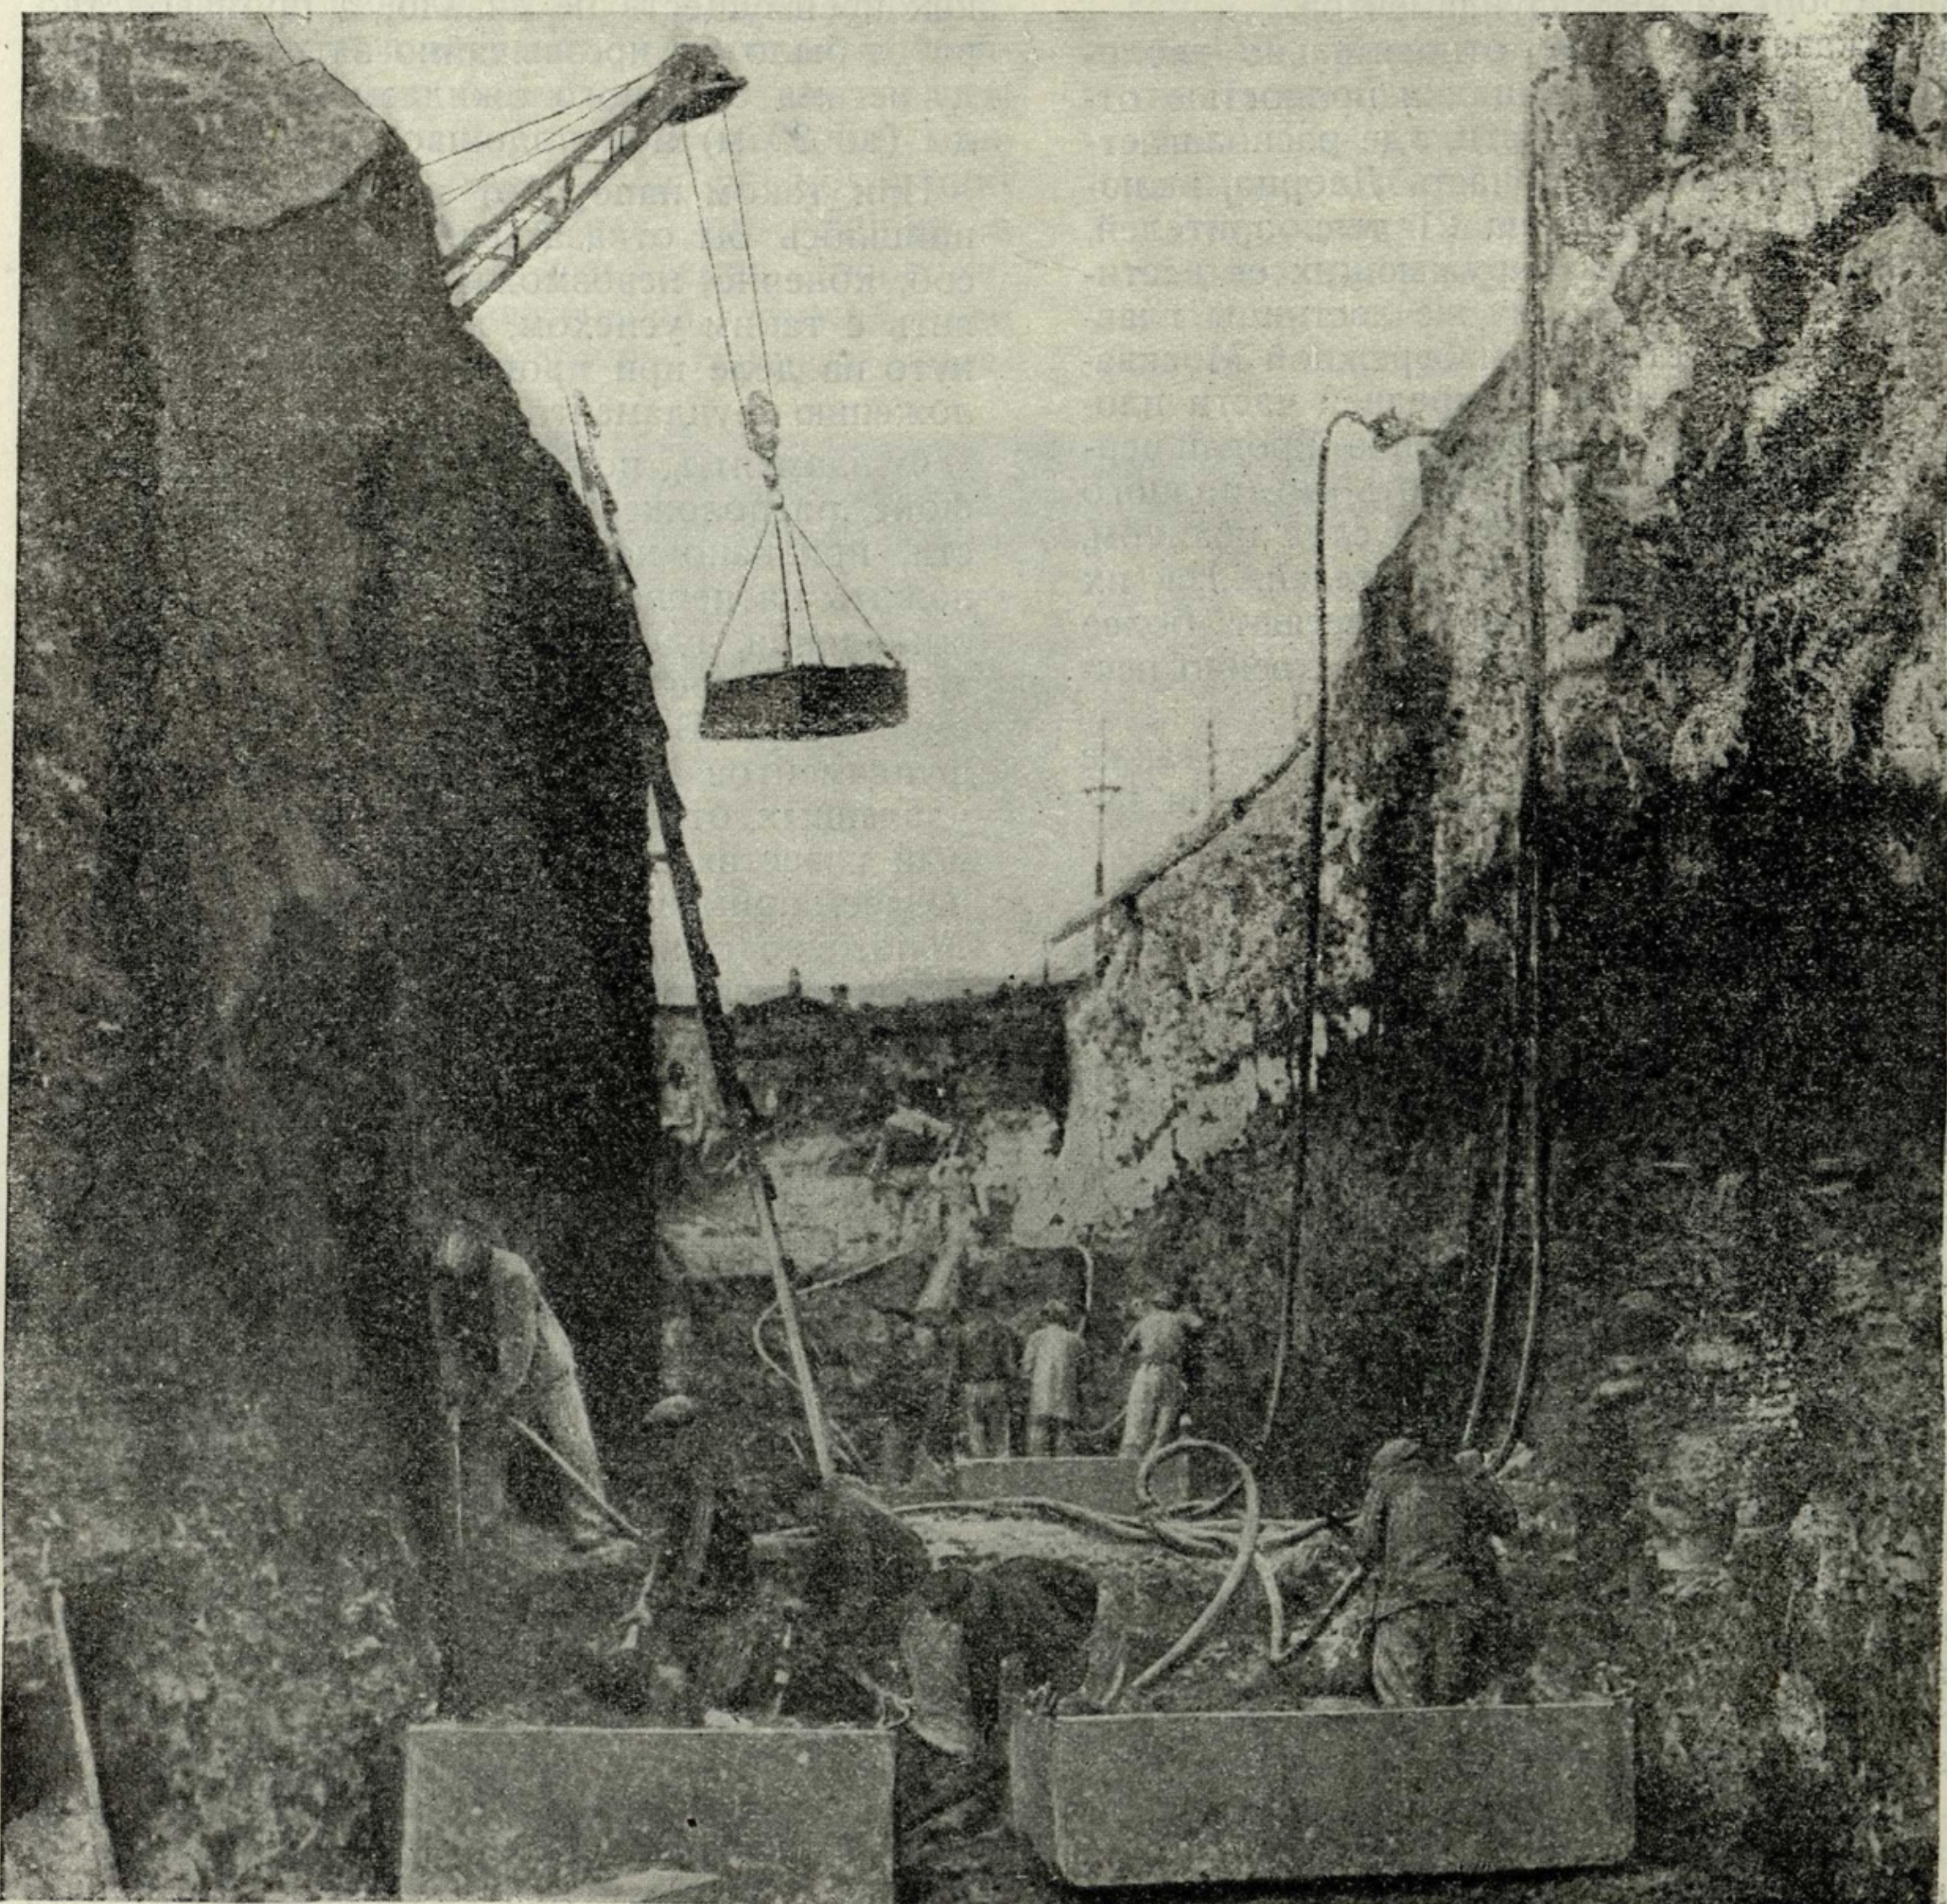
Разработка траншеи для кольцевого фундамента под главные колонны высотной части. Разработка ведется пневматическими отбойными молотками. На переднем плане и справа видны шланги, подающие сжатый воздух. На заднем плане виден груженный лоток, удаляемый краном из траншеи.
